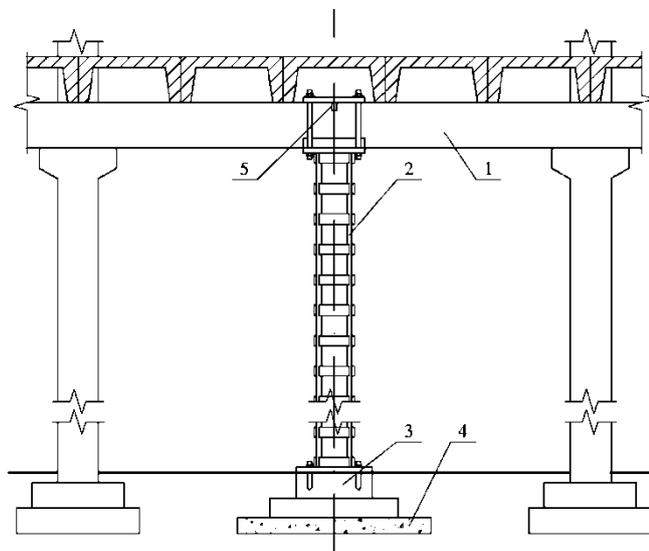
Усиление конструкции дополнительной жесткой опорой с самостоятельным фундаментом: 1 – усиливающая конструкция; 2 – стойка дополнительной опоры; 3 – фундамент опоры; 4 – песчано-щебеночная подушка; 5 – надрез на глубину на 50мм
